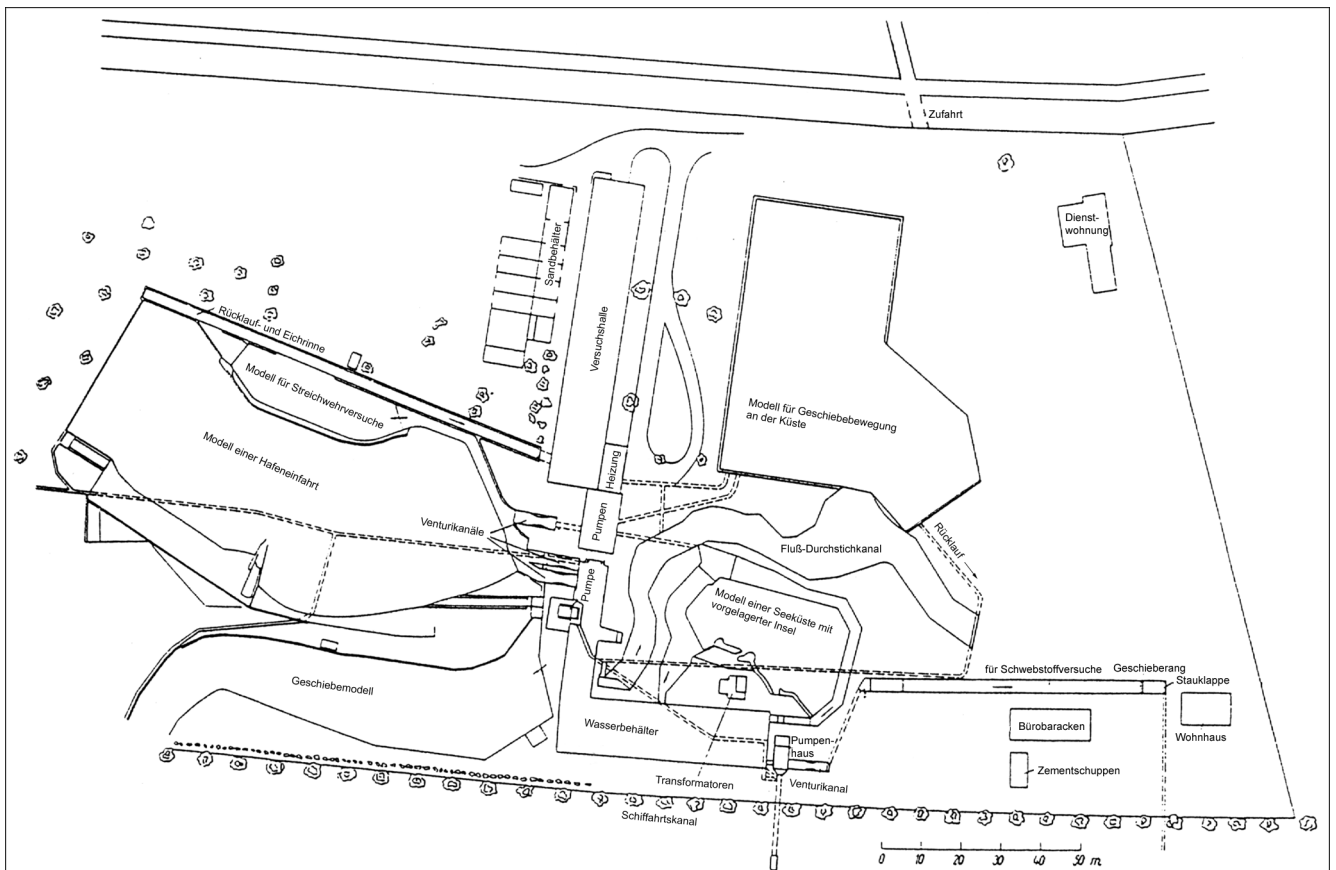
Lageplan der Versuchsanstalt Potsdam der Abteilung Wasserbau und Schifffahrt der Forschungsanstalt, Ausbausituation 1953
